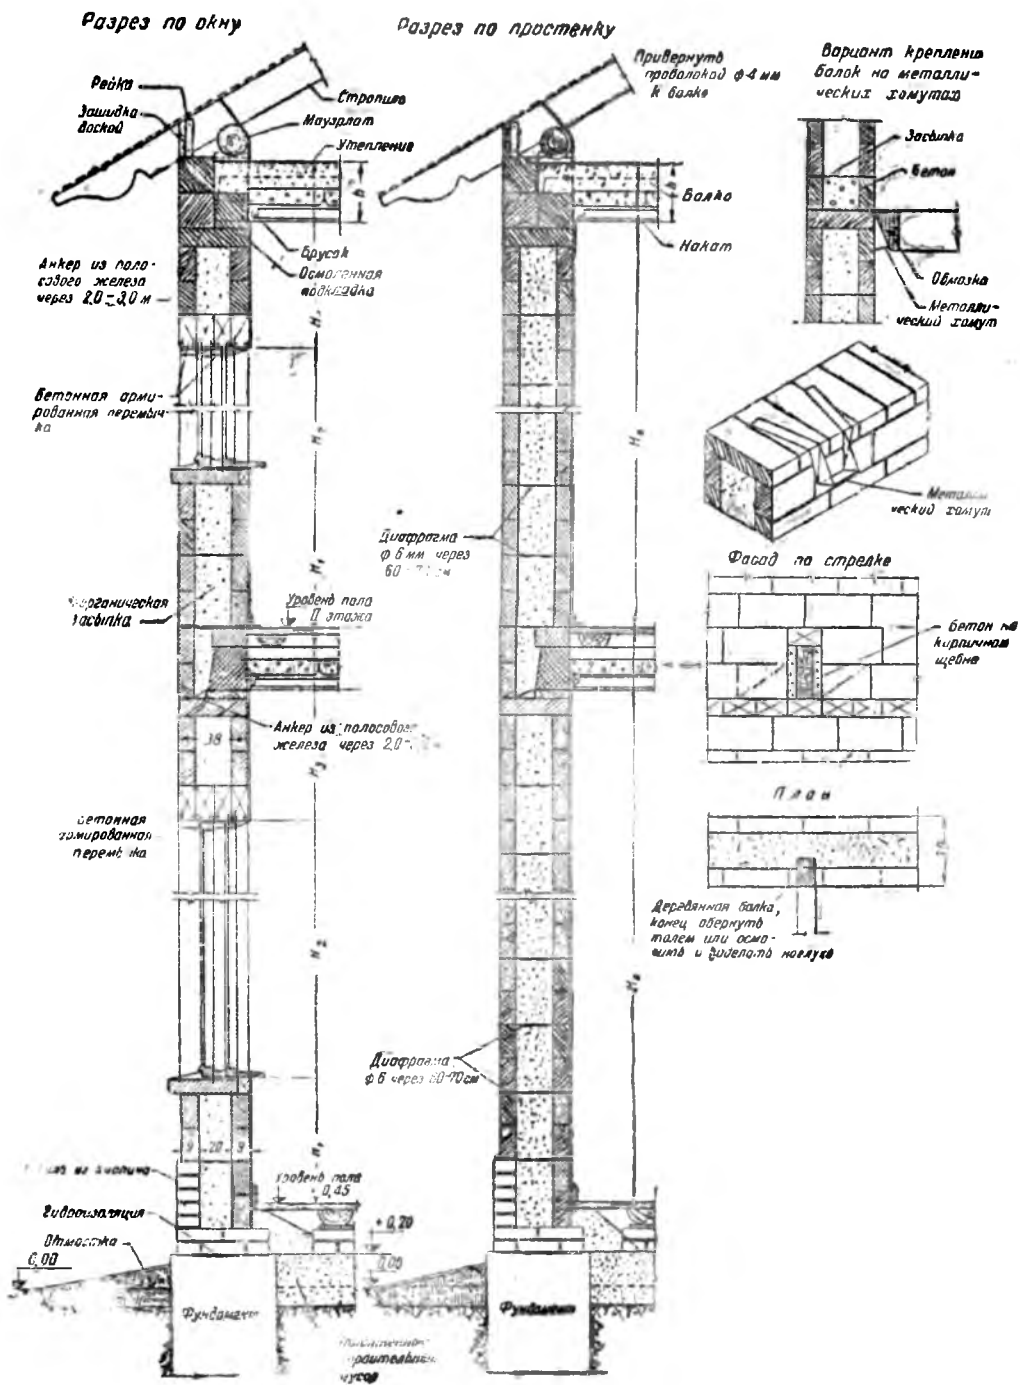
Засыпные стены из утолщенных блоков. Разрезы по двухэтажной стене. Детали опирания балок
